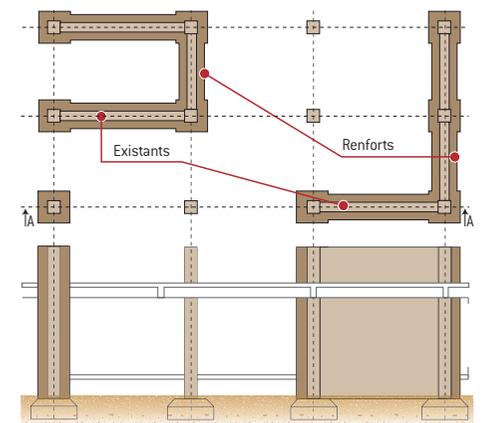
Exemple de renforcement de poteaux, murs, par chemisage en béton projeté (vue en plan et coupe AA)
